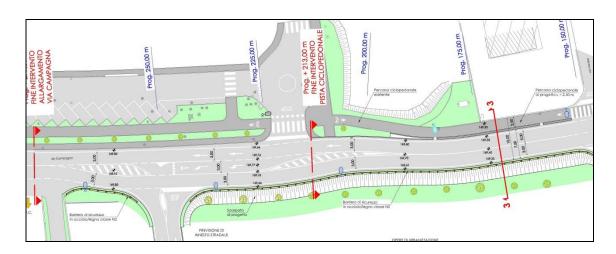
Planimetria progetto generale e accesso canalizzato Via Campagna
